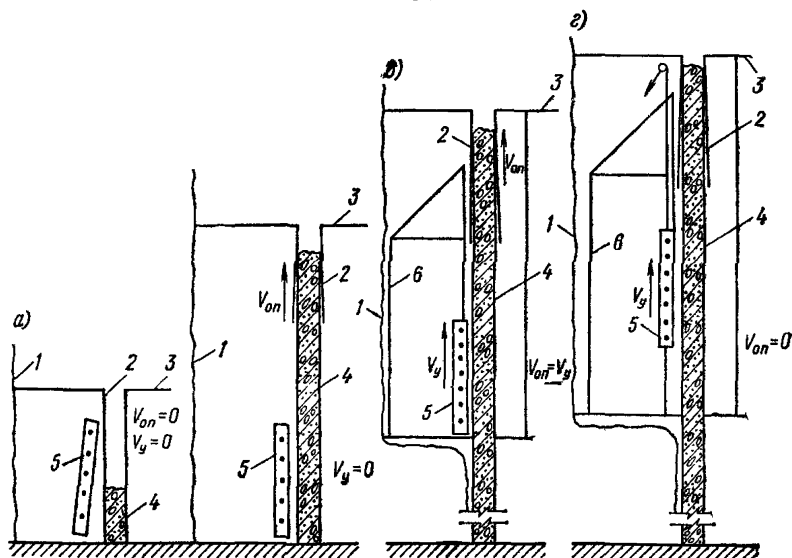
Схема инфракрасного обогрева бетона конструкции, возводимой в скользящей опалубке
